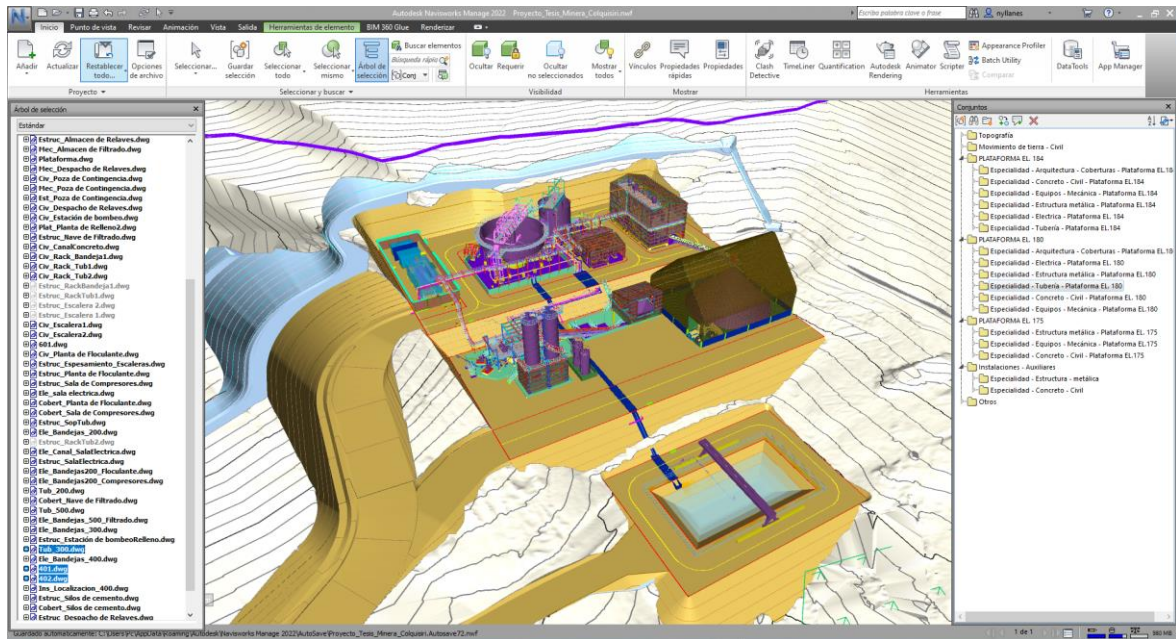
Especialidad de concreto, estructura metálica, equipos mecánicos, Eléctrica y Arquitectura.
